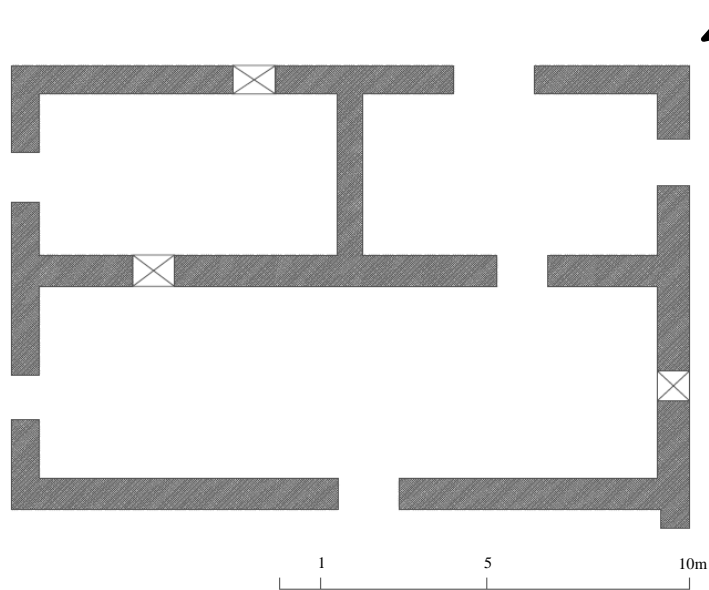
Esboço da planta da Albergaria de Canaveses.
